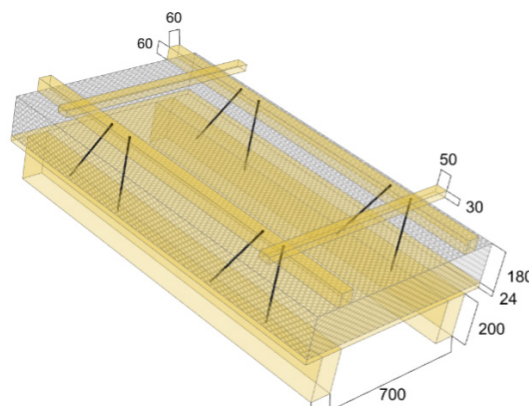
Systemherstellerseitige Dokumentation zur Dimensionierung der Schrauben.
